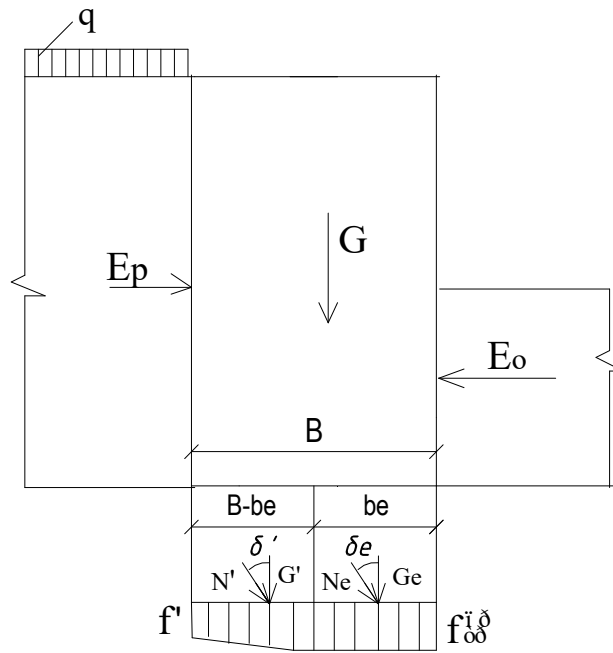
Расчетная схема к определению зон предельного и допредельного напряженного состояния грунта основания
